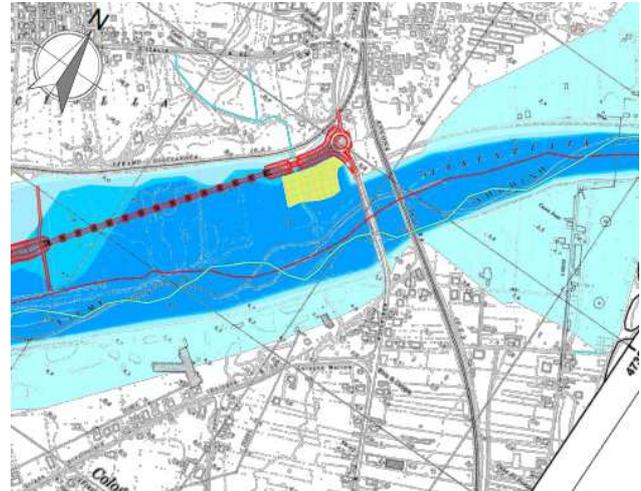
Dettaglio sovrapposizione Area Cantiere Logistico LC02
